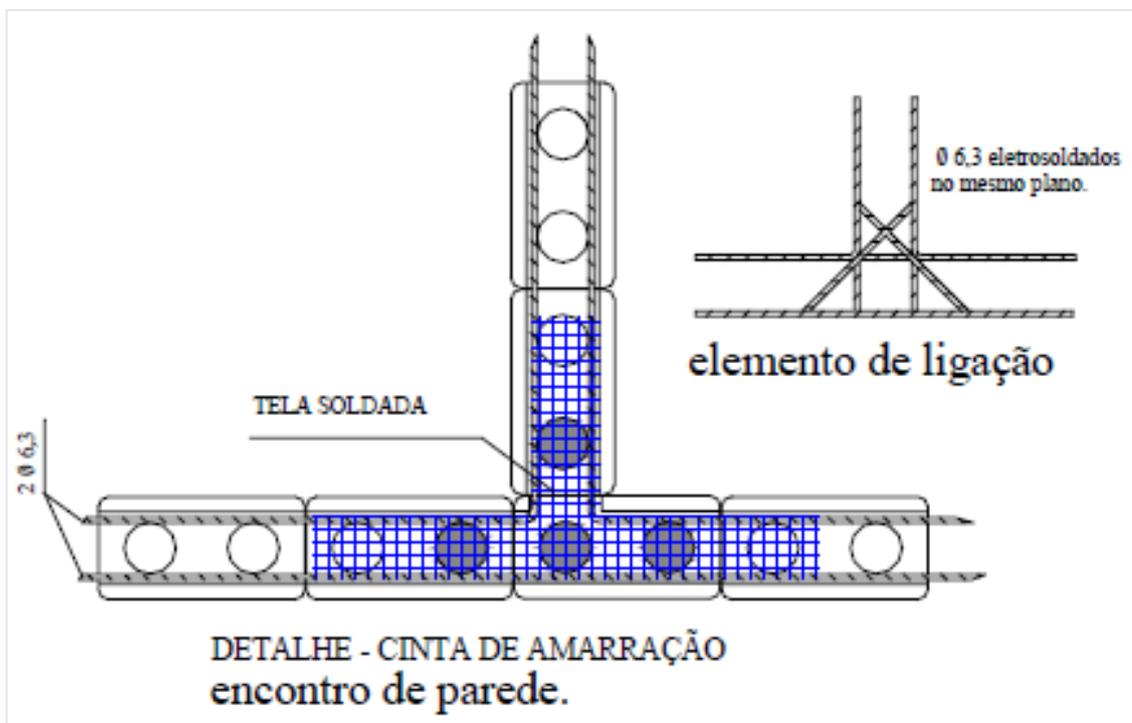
Detalhes sugeridos para as cintas de amarração em cantos de parede.
